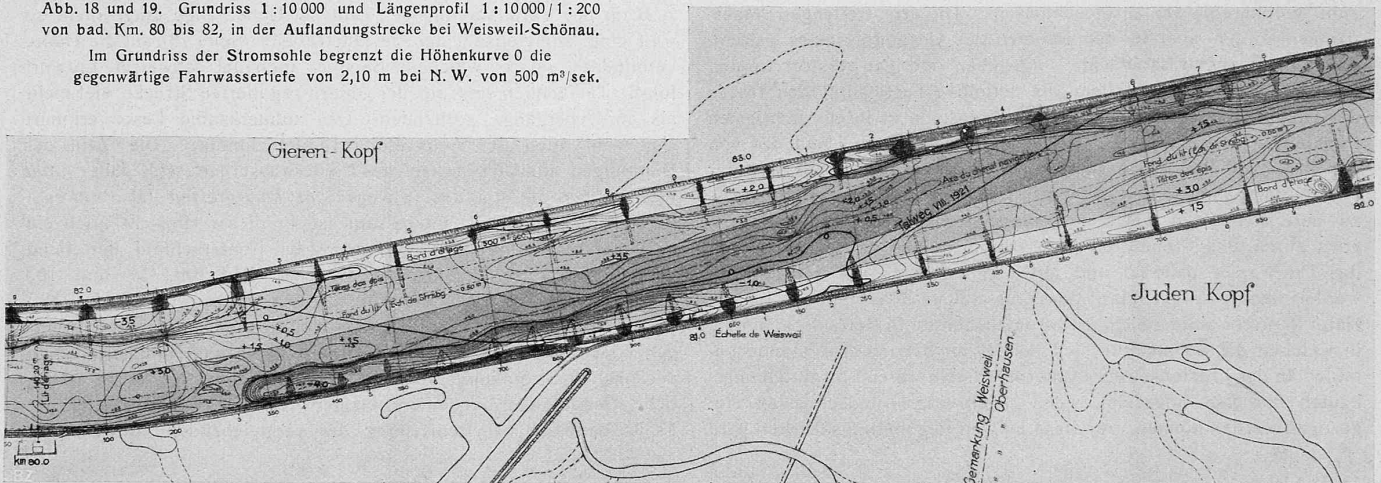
und 19. Grundriss 1:10 000 und Längenprofil 1:10 000/1:200 von bad. Km. 80 bis 82, in der Auflandstrecke bei Weisweil-Schönau.
